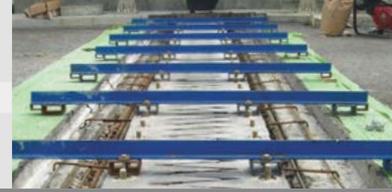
Joints de dilatation sur voiries séparées (joint de chaussée et joint de plateforme)
